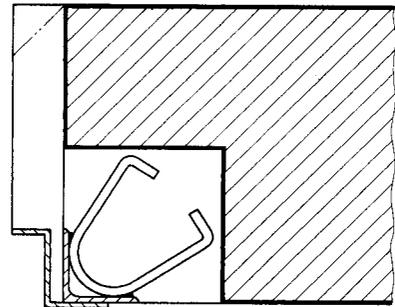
Anschweißanker, Einbaubeispiel (Grundriß) dicke Wand, nur Leibungsfläche geputzt, Befestigung der Zarge am Anschweißanker mittels Schweißung mit Paßstücken (nicht dargestellt) oder Zargensteg an Winkel angeschweißt (nicht dargestellt), Befestigung des Anschweißankers im Ankerloch wie Maueranker
